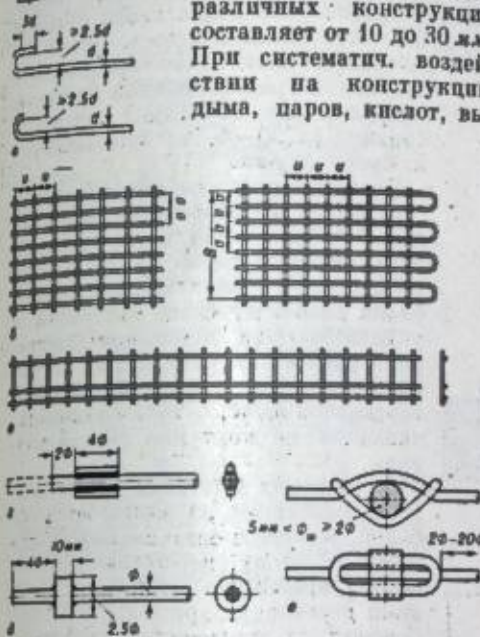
Средства для увеличения сопротивления арматуры скольжению в бетоне: а — крючки ручной и машинной выработки; б — сварные сетки; в — плоский сварной каркас; г — анкер с приваренными коротышками; д — анкер с приваренной шайбой; е — анкер в виде колец («петля»).
